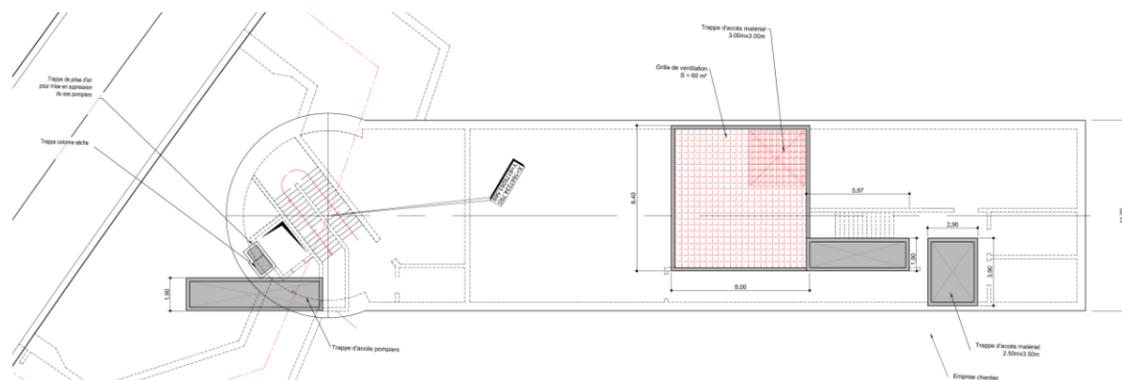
Vue en plan de l'ouvrage de type Puits de décompression, ventilation et accès de secours (exemple : « Cimetière Parisien »)
